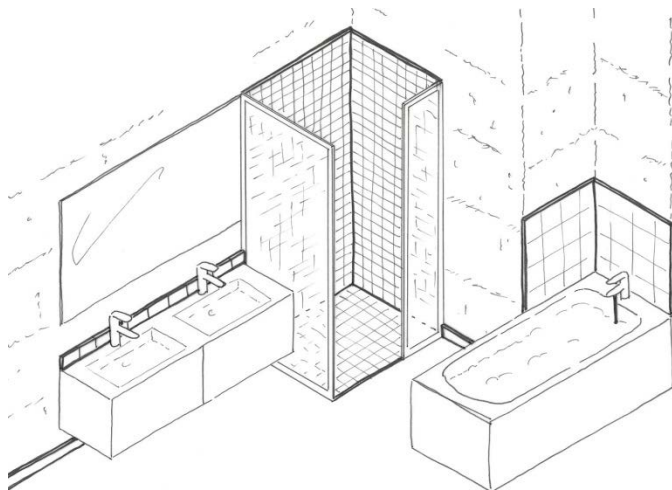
Exemples de protection de jonction entre le mur en bauge et une surface horizontale ou inclinée
